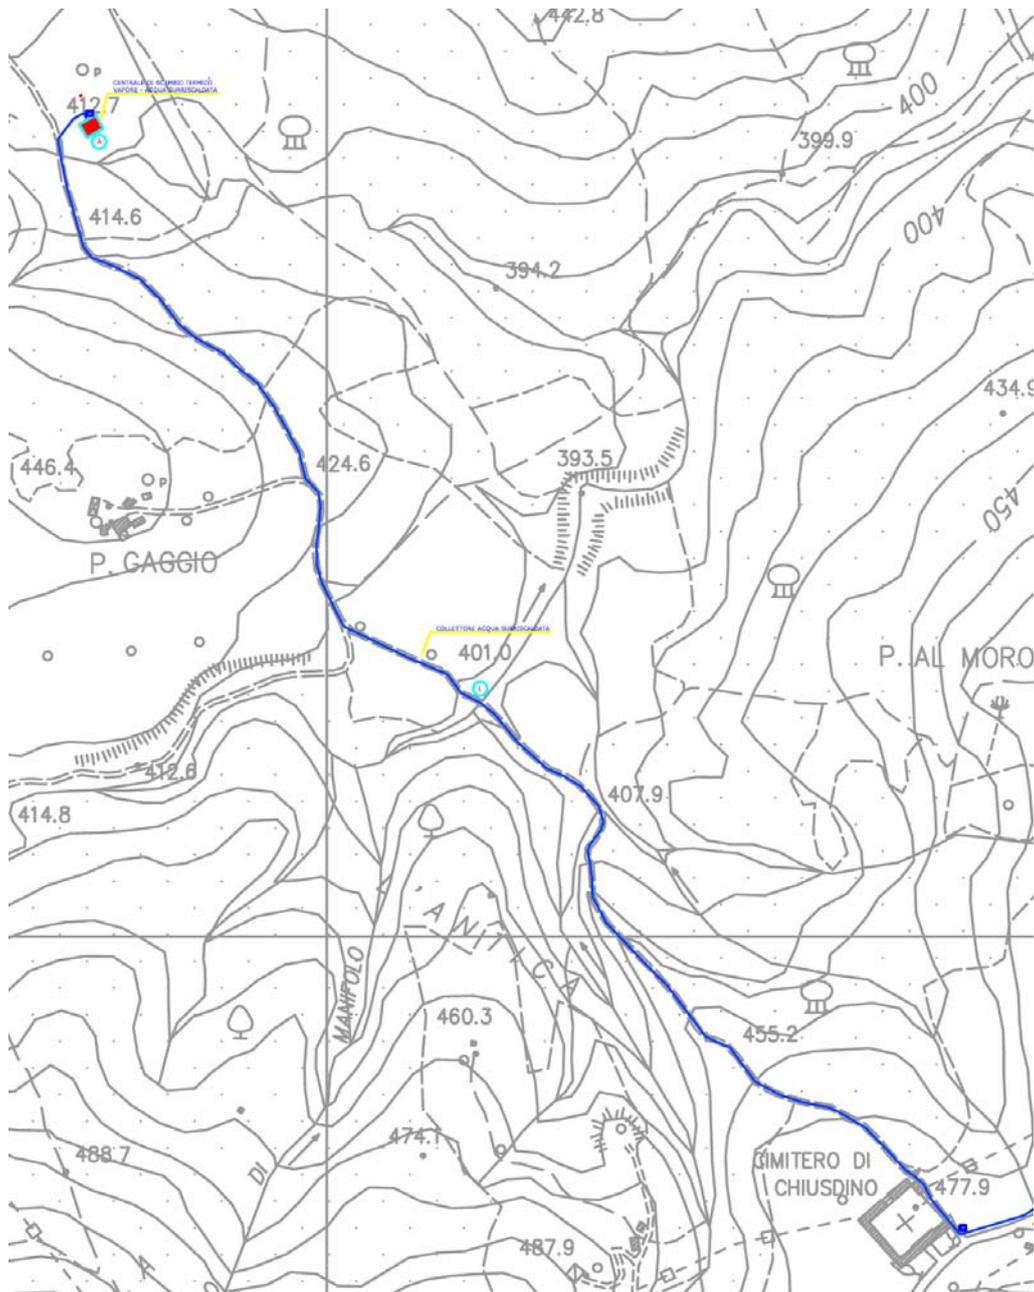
Dettaglio planimetrico rete di teleriscaldamento – tratto acqua surriscaldata
